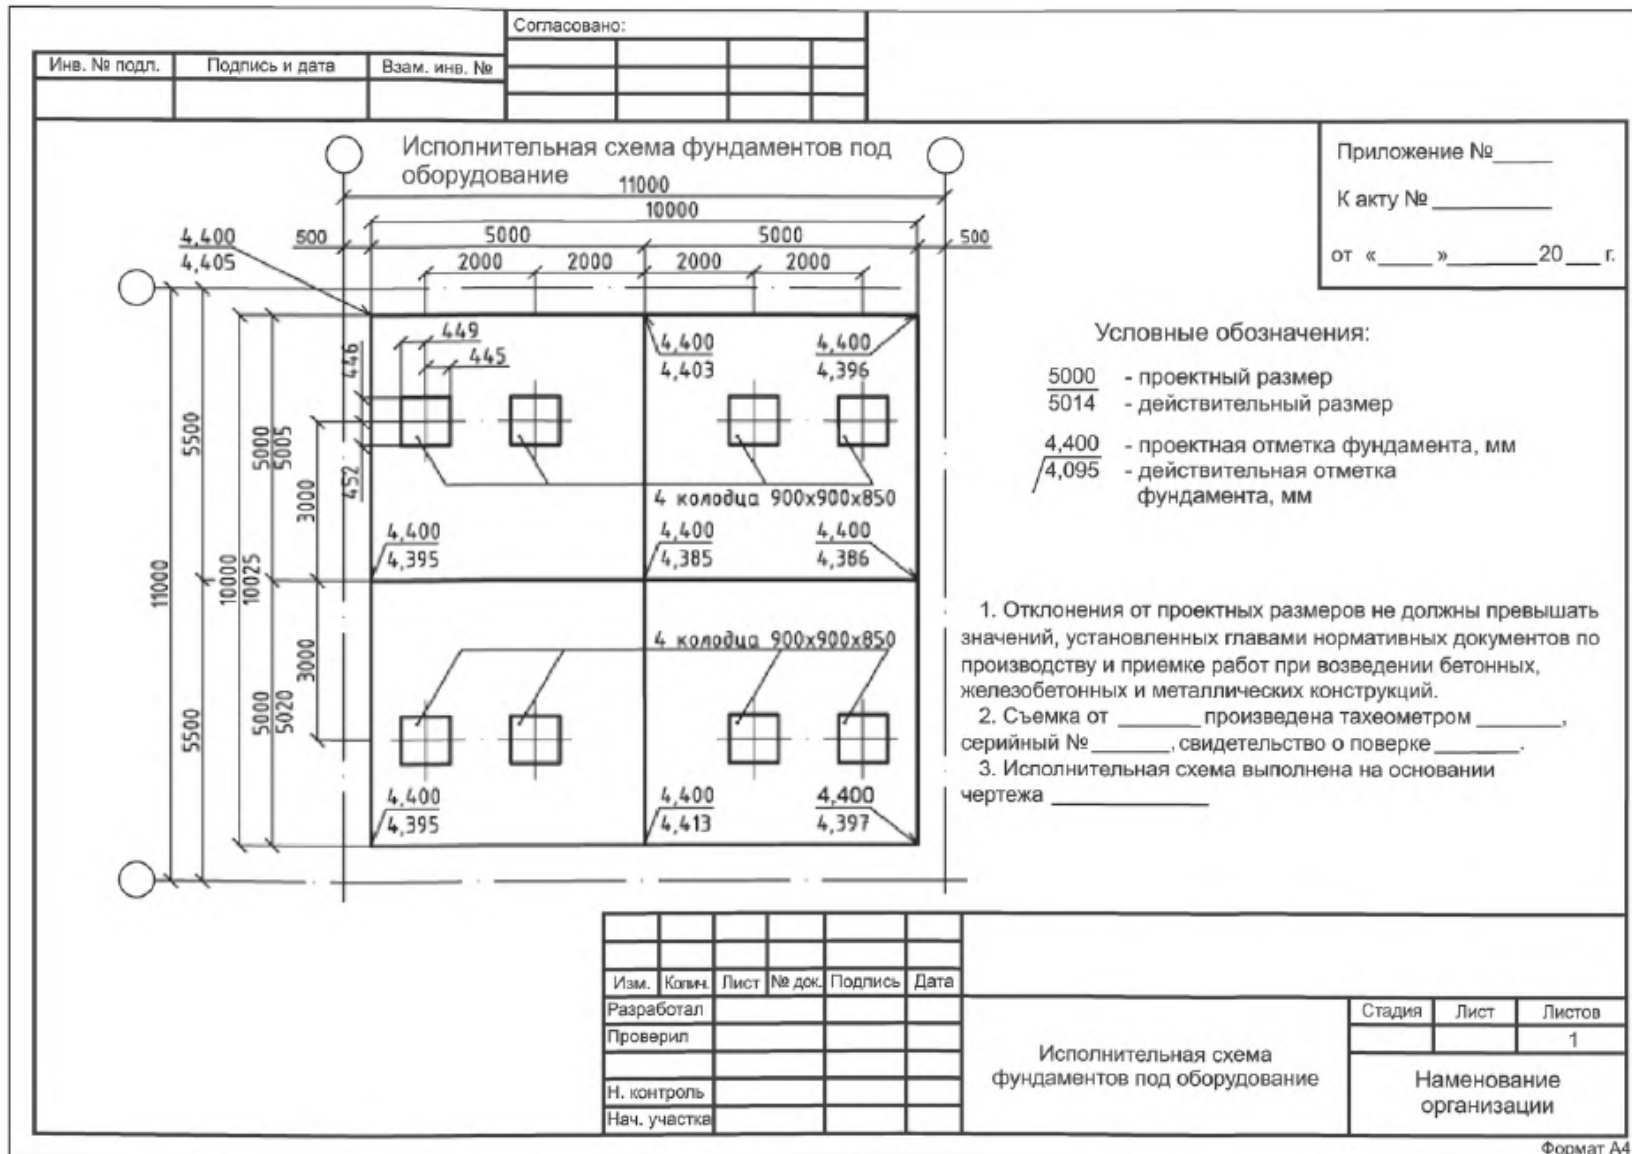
Исполнительная геодезическая схема. Фундаменты под оборудование
